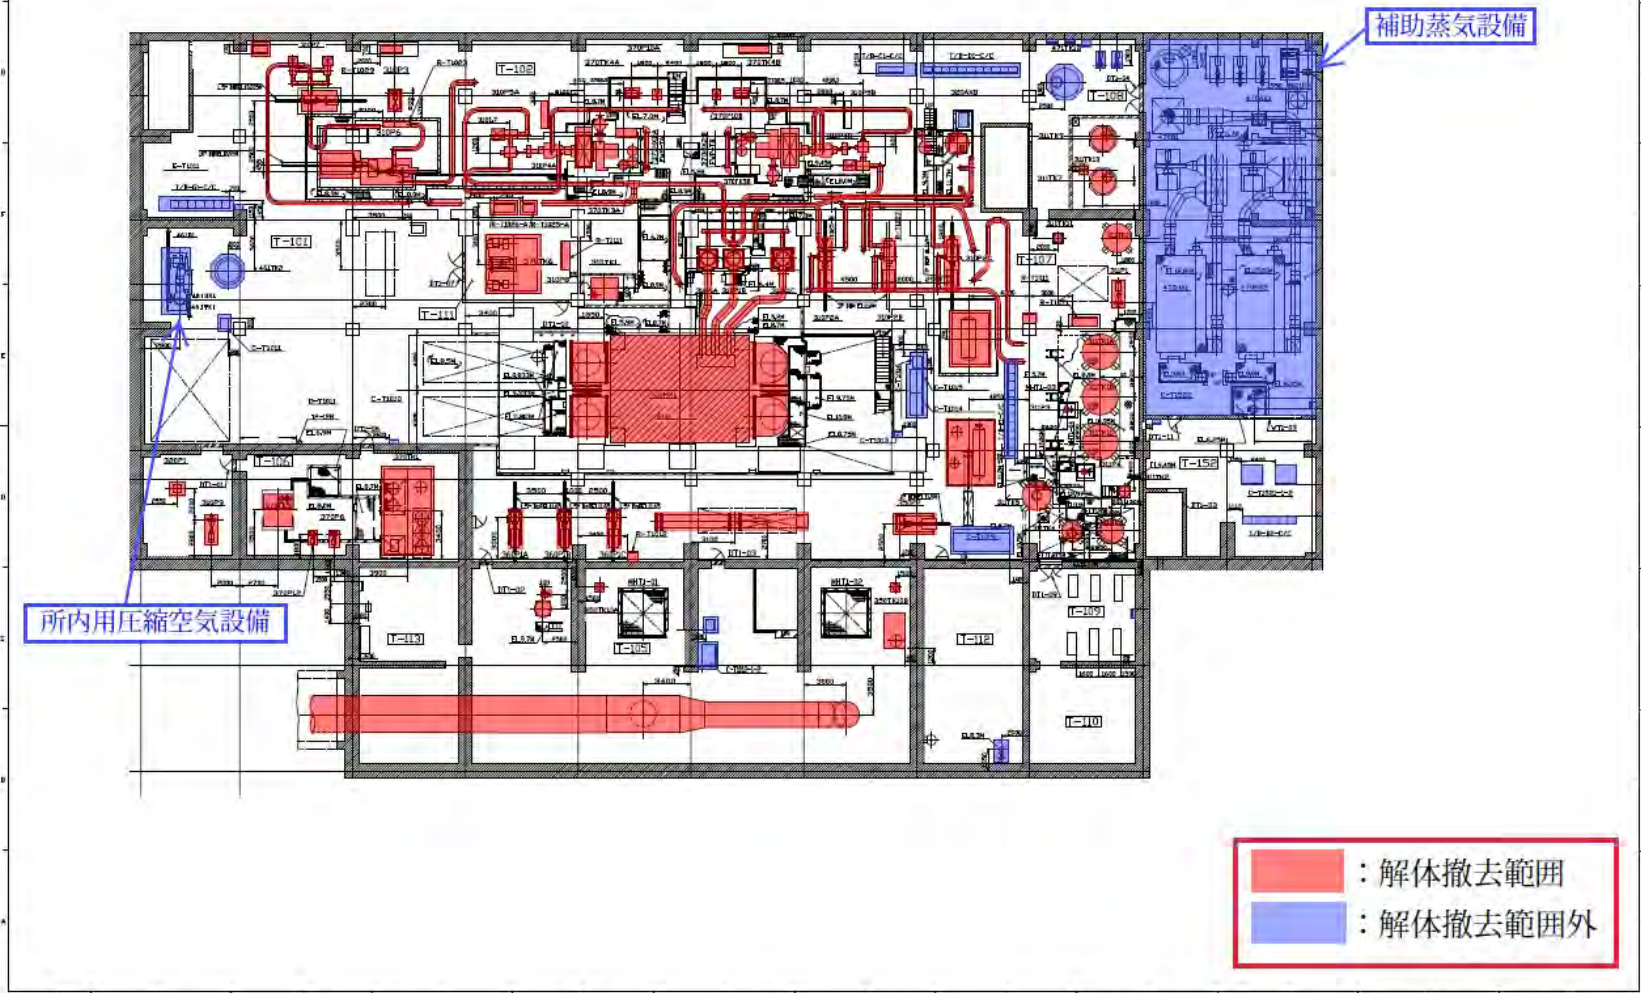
主な解体撤去機器 (タービン建物平面図) (6/7)
